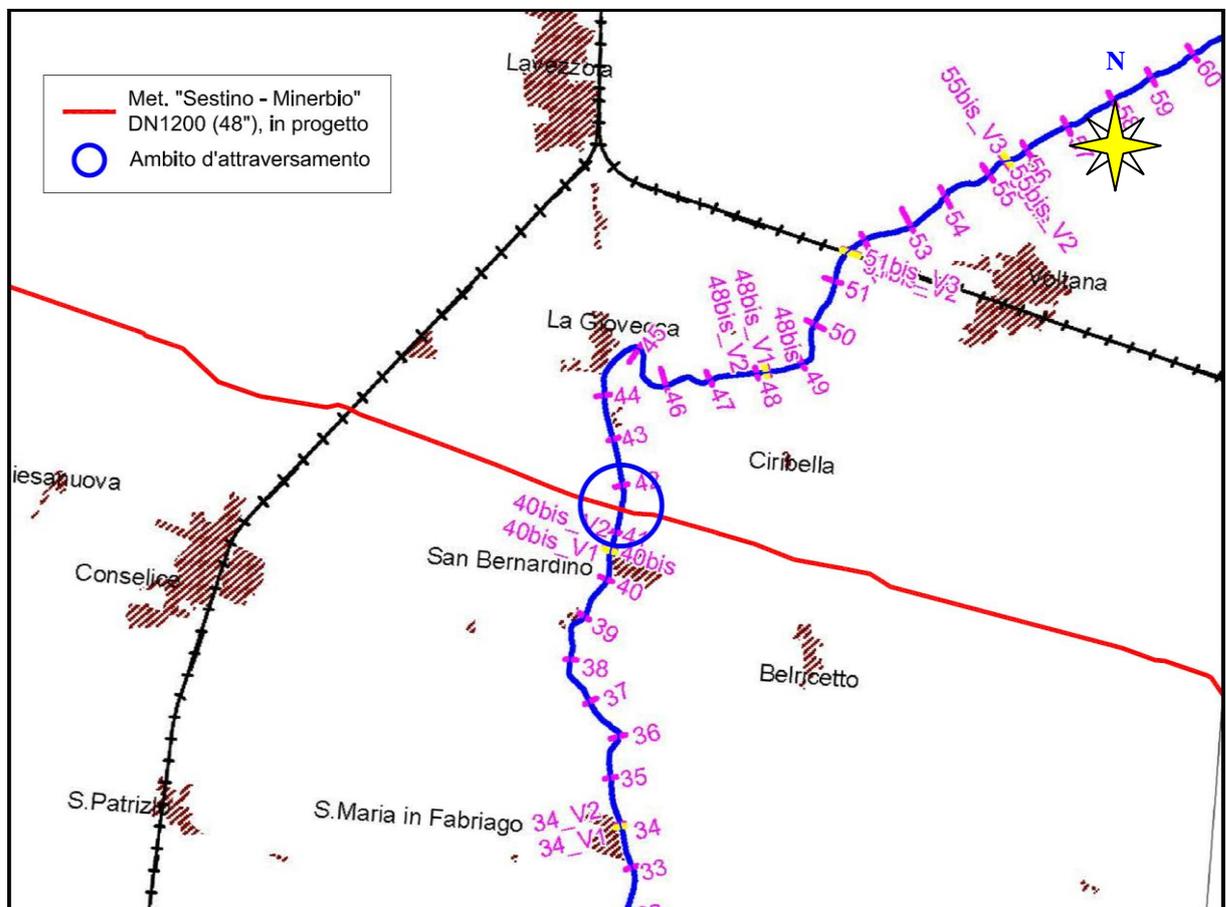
/A: Stralcio planimetrico con sezioni considerate nella modellazione idraulica ed individuazione dell'ambito di attraversamento
